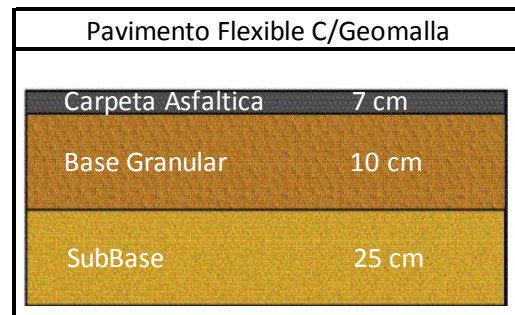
Estructura del pavimento Flexible con geomalla triaxial.
